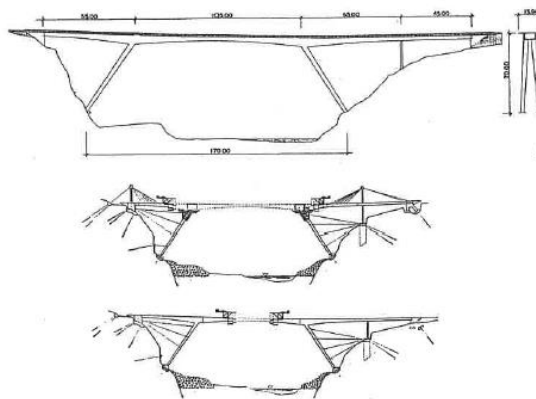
Construcción con atirantamiento de pilas inclinadas
